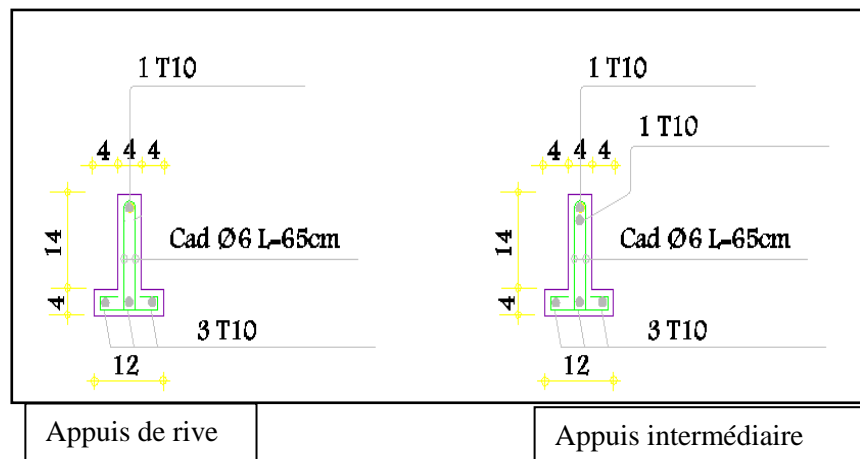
Dessin de ferrailage des poutrelles du plancher terrasse
